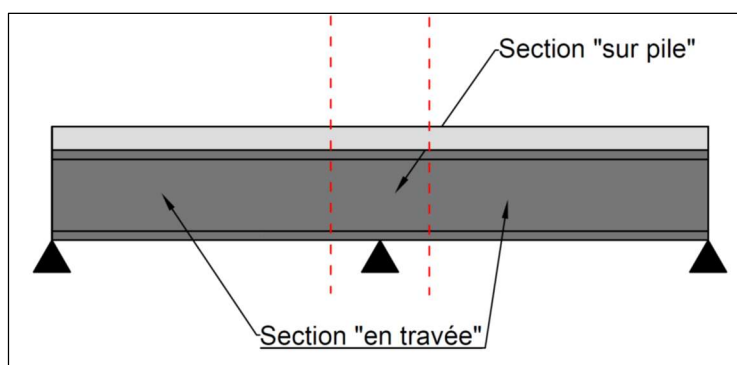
Coupe longitudinale d'un bipoutre - Sections sur piles et sections en travées
